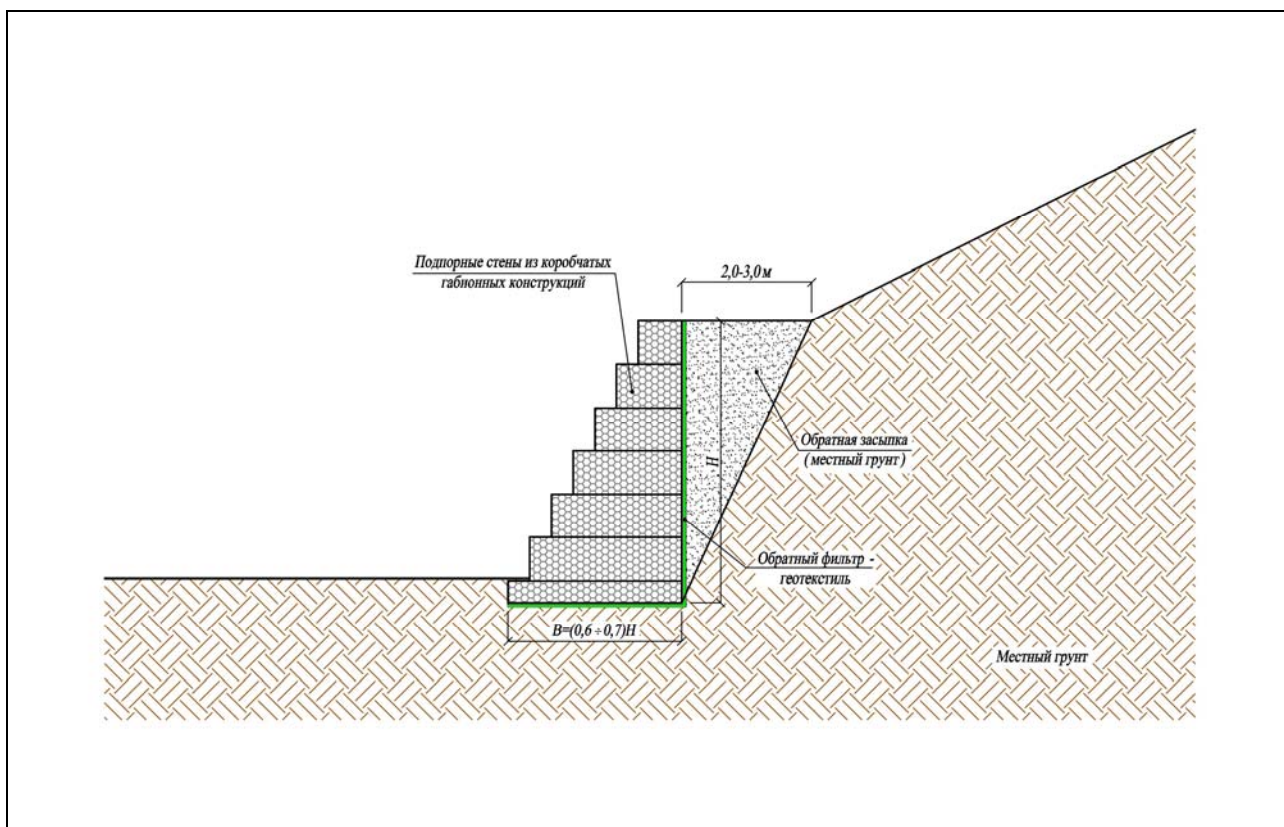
Схема подпорно-удерживающего сооружения из коробчатых габрионных конструкций с устройством промежуточной бермы
